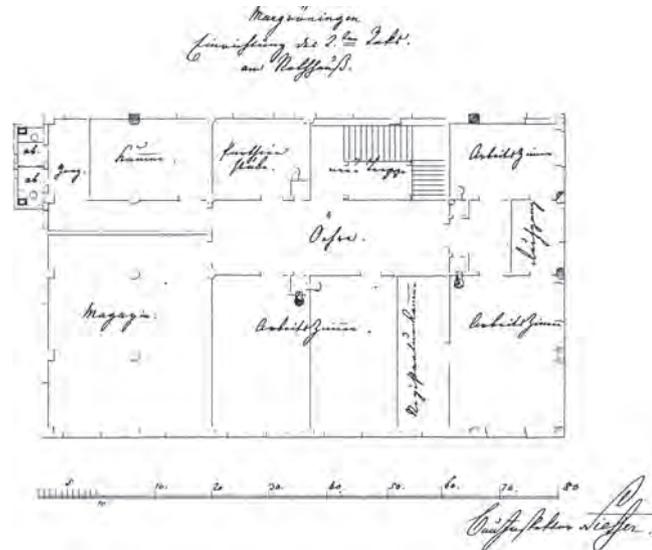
1. Obergeschoss, geplanter Ausbau 1848 (Zeichnungen: Nieffer, StadtA M, M 01 Bü 193)
